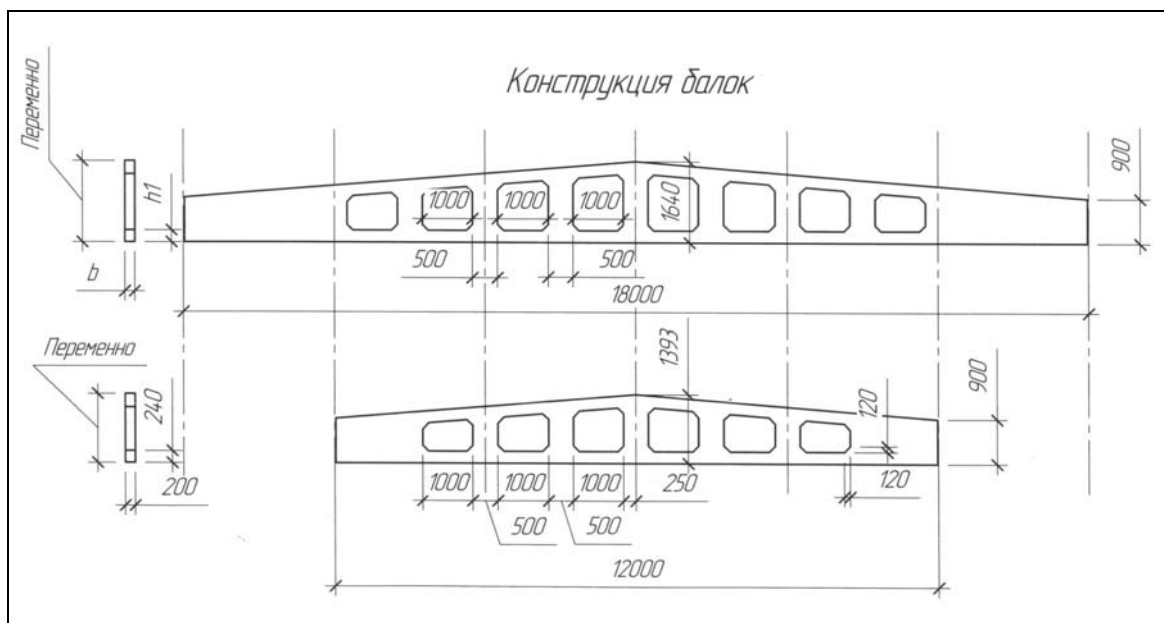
Конструкция балок скатных покрытий пролетом 12 и 18 м
